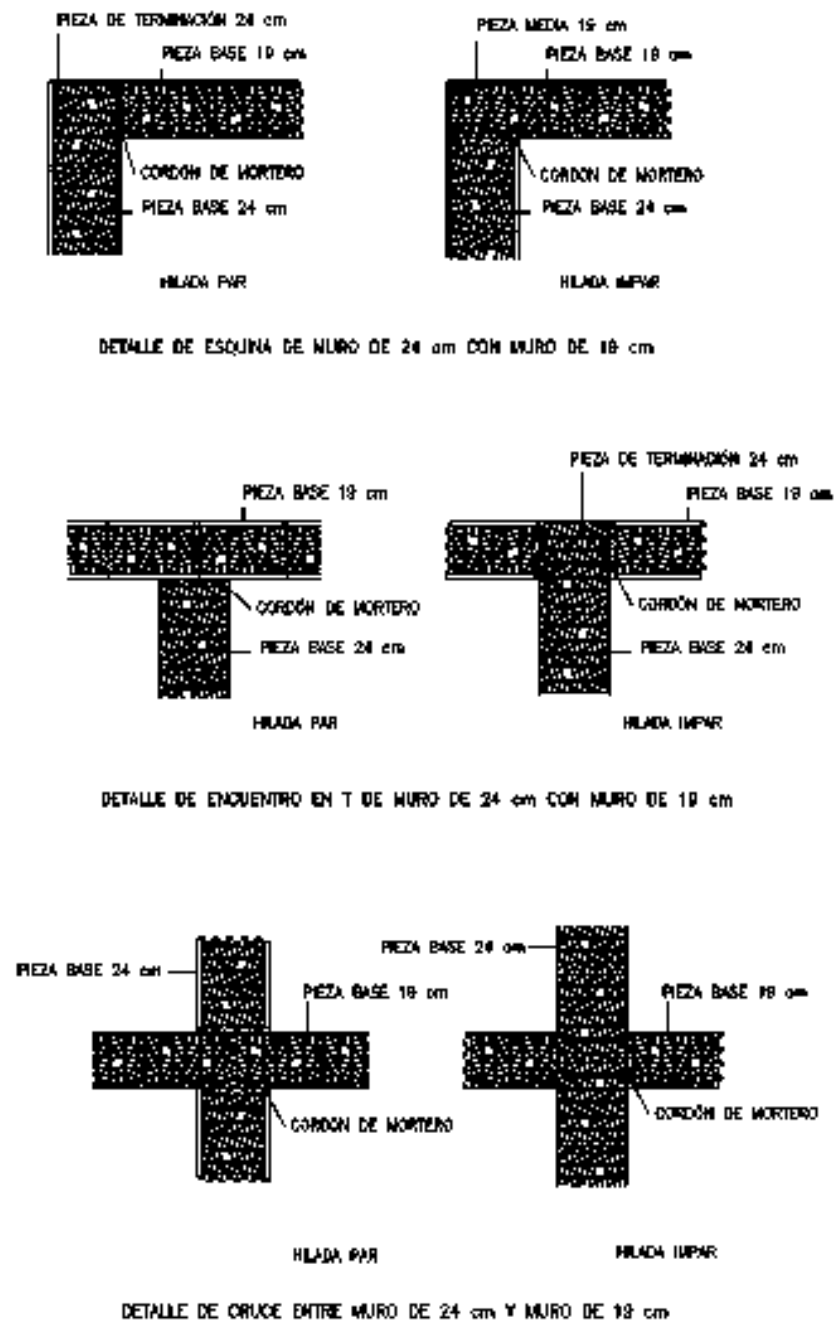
Detalles de encuentro de piezas de 24 cm con piezas de 19 cm.
